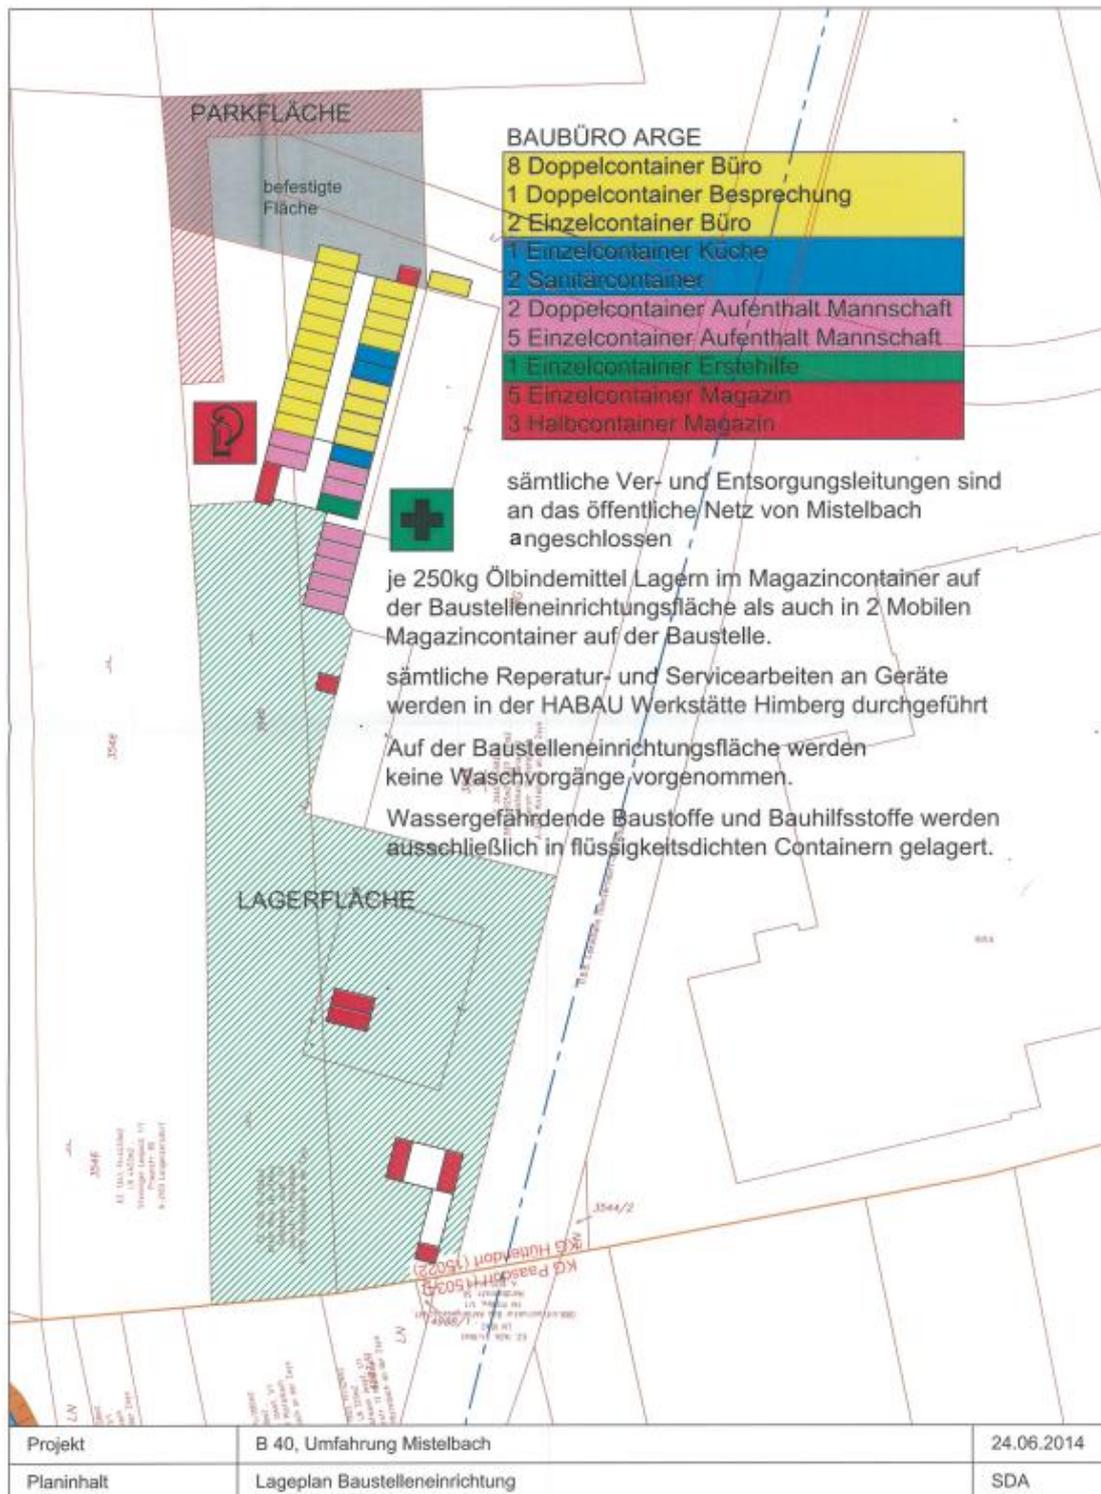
Lageplan Baustelleneinrichtung²²⁹
